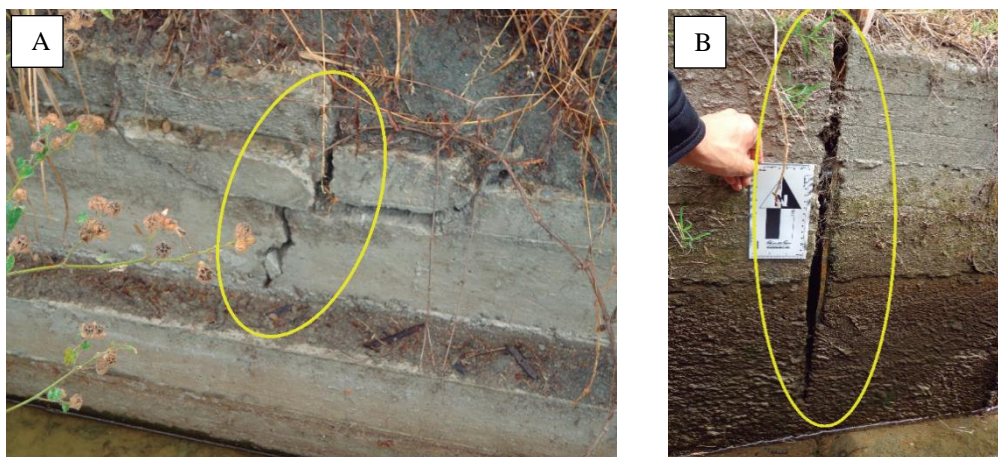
Tramo del canal que presenta daños CM3 a) Reparación de grietas verticales b) Reparación de grietas horizontales
